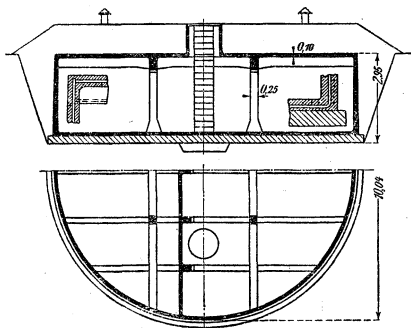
zeigt eine wasserdichte Kesselhausanlage. Umfassungswände in Stampfbeton, Zwischenwand, Decke und Bodenplatte (auf Magerbetonschicht) in Eisenbeton. Wasserdichter Verputz der Innenmauerung durch Klinkerschicht und derjenige der Bodenplatte durch 8 cm starken Betonboden geschützt.
